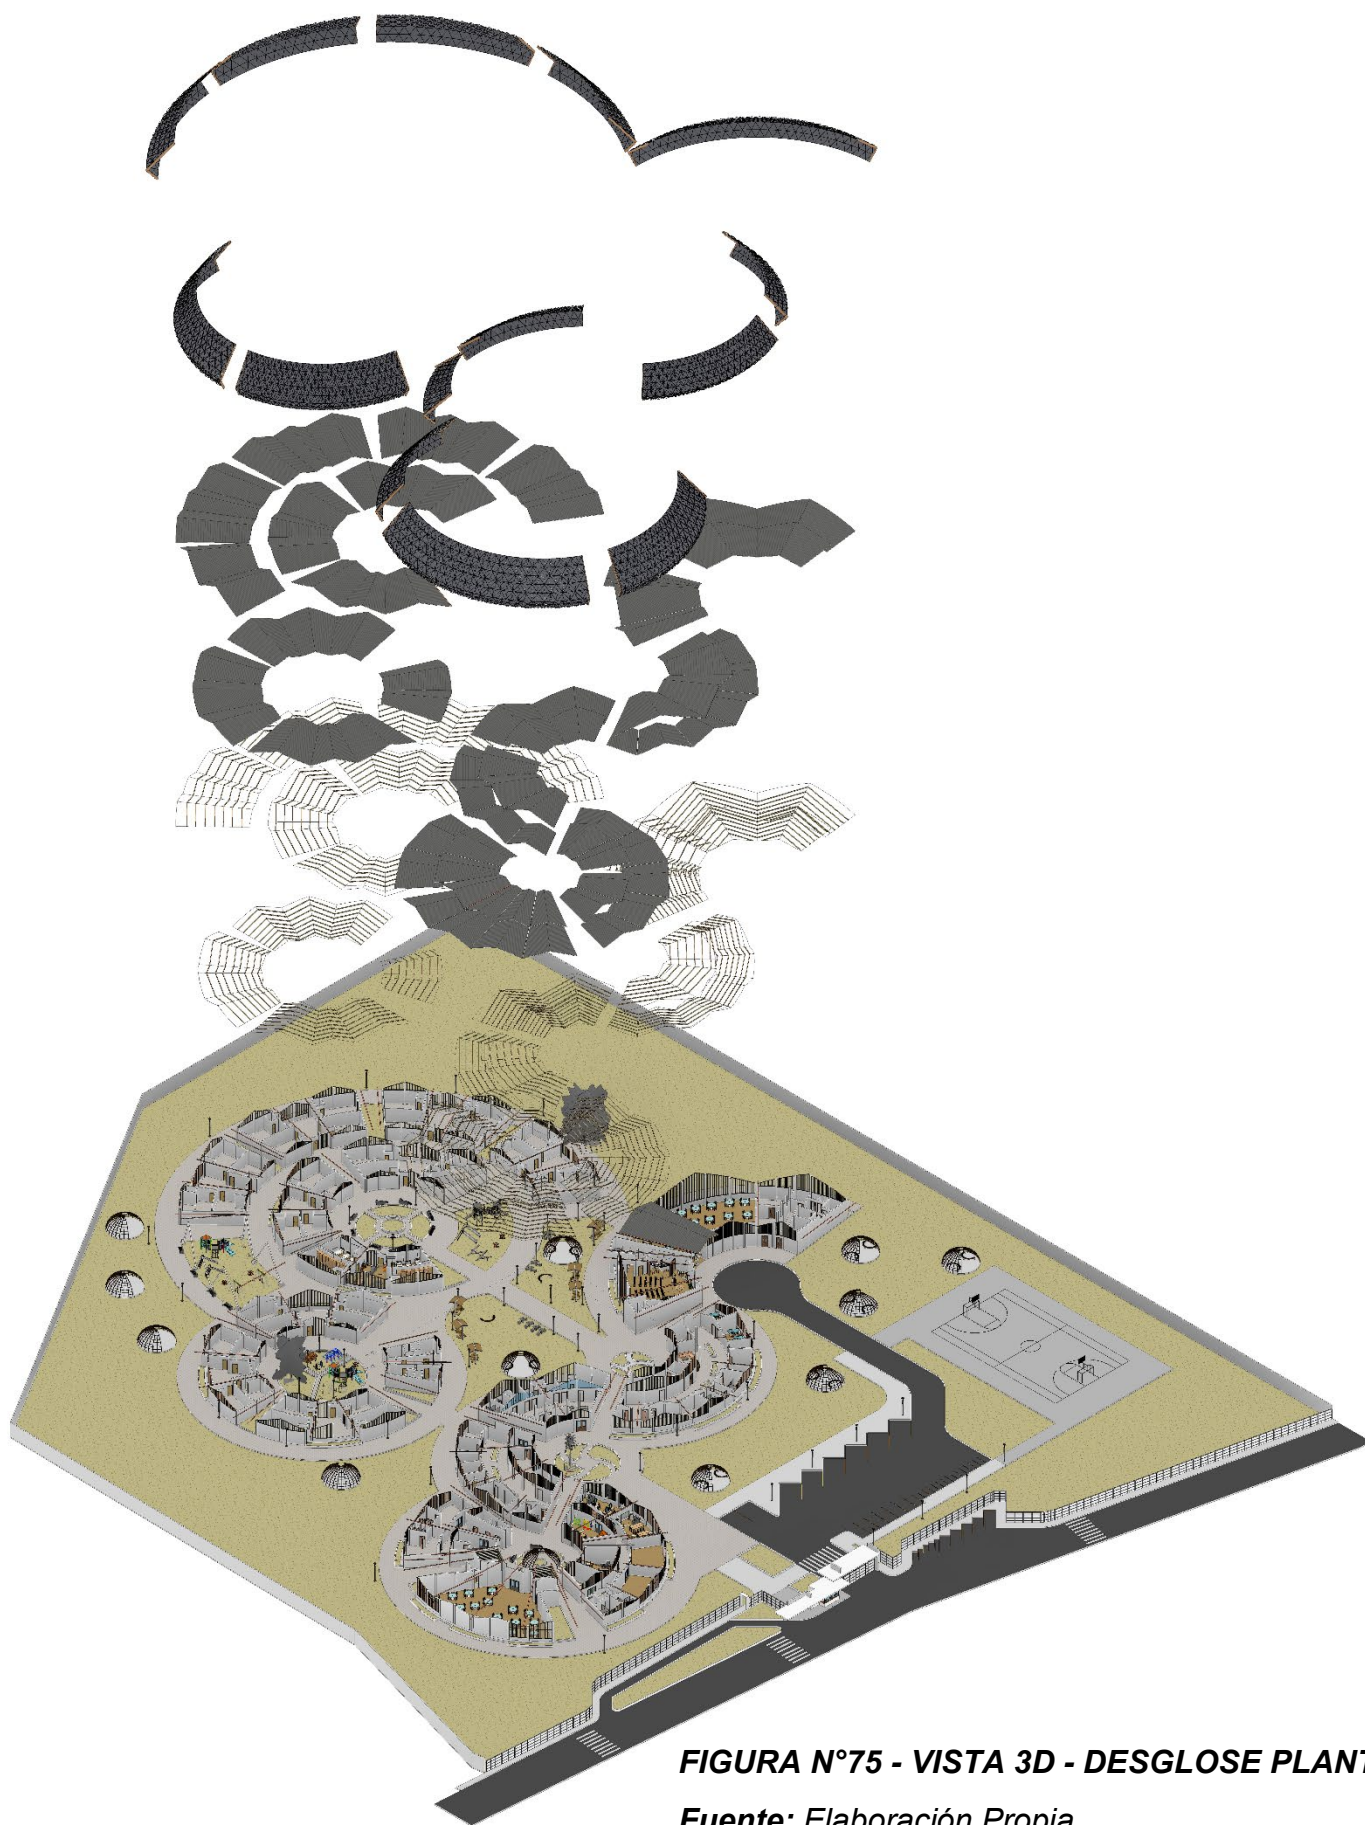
VISTA 3D - DESGLOSE PLANTA
